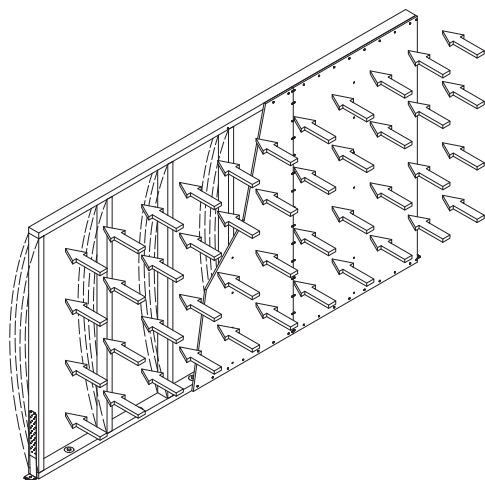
Parete Platform soggetta ad azioni orizzontali ortogonali al piano.
